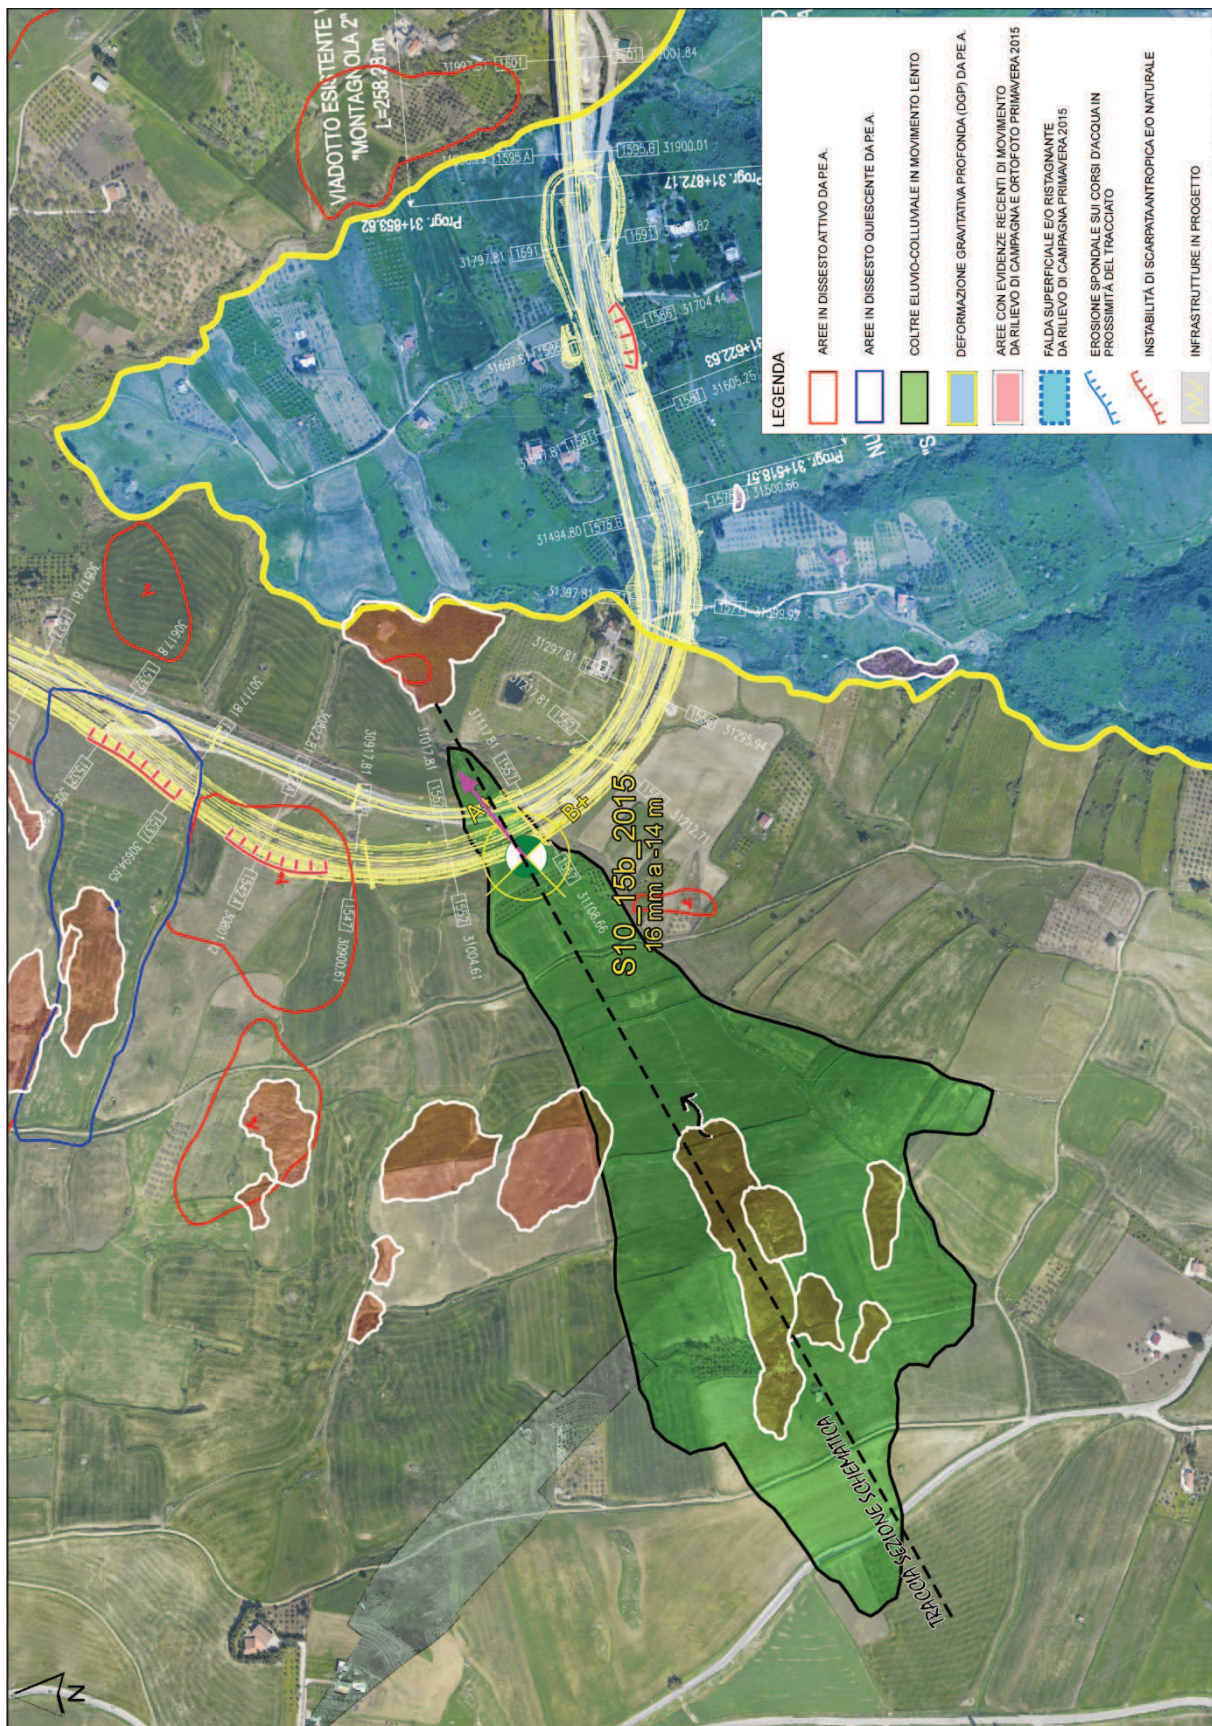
PK 31+087. Individuazione planimetria dell'area in movimento
